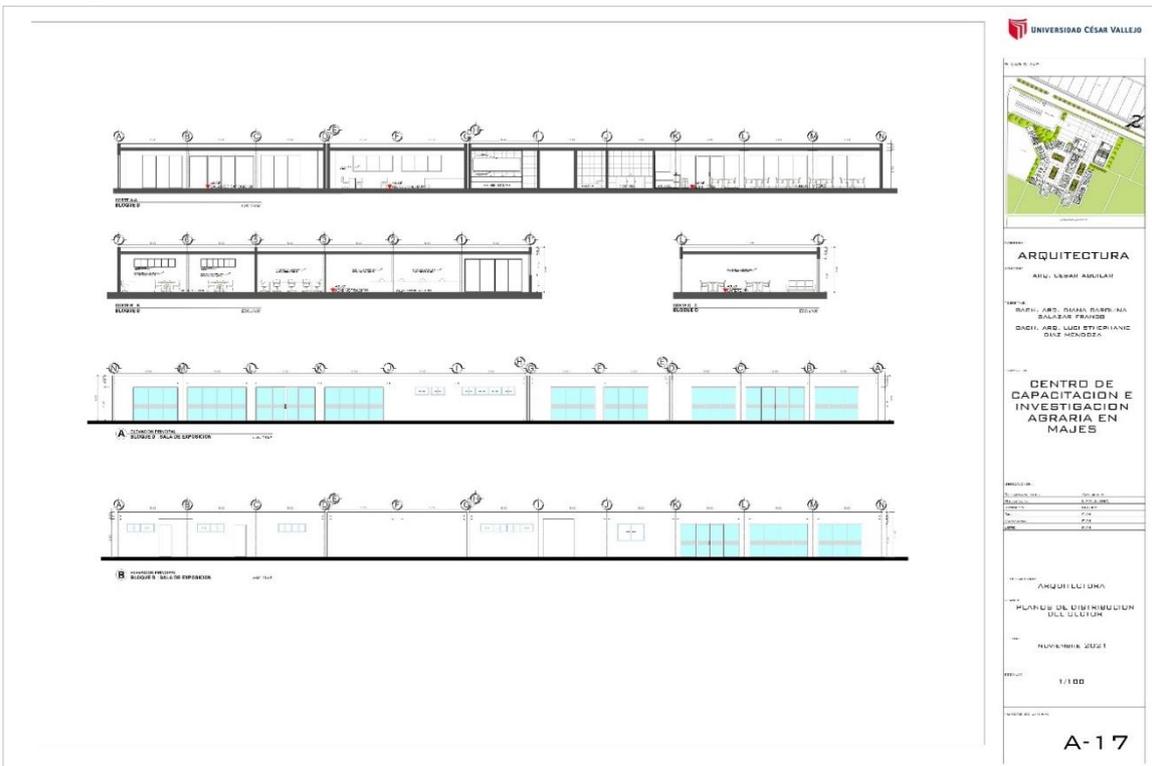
Plano de Corte y elevaciones por Sector: Bloque E
